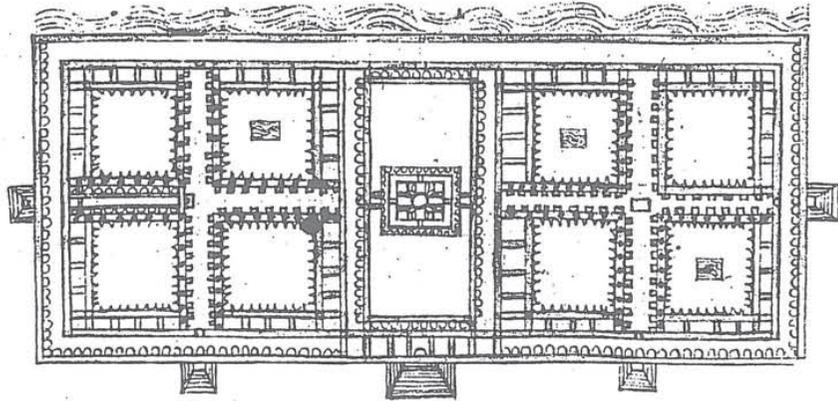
Diseño de planta y alzado de Antonio Averlino, llamado Filarete.
